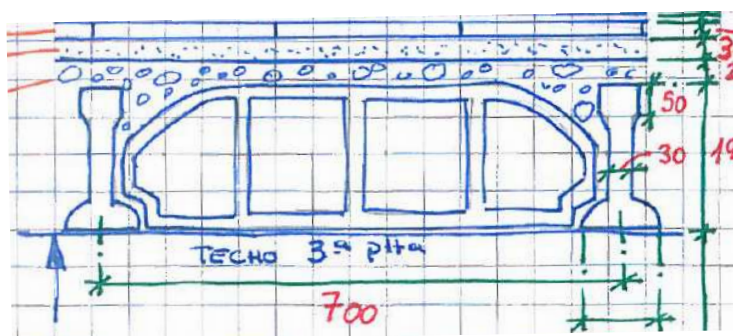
Tipo de Forjado en Edificio 84C.017, 1960.
